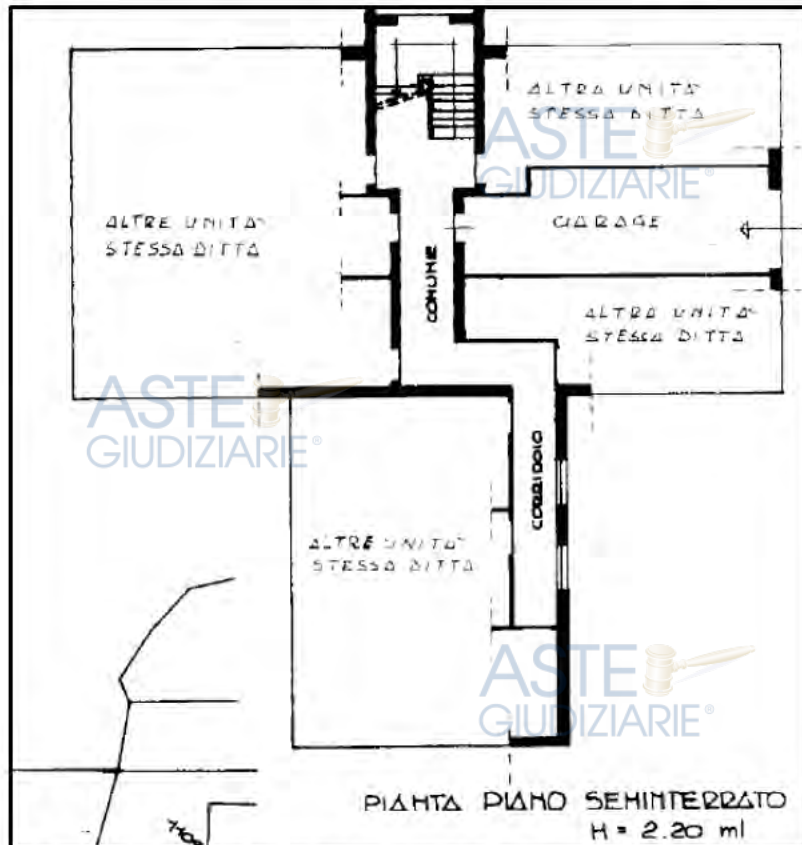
Estratto della scheda planimetrica del garage (Catasto Fabbricati)
